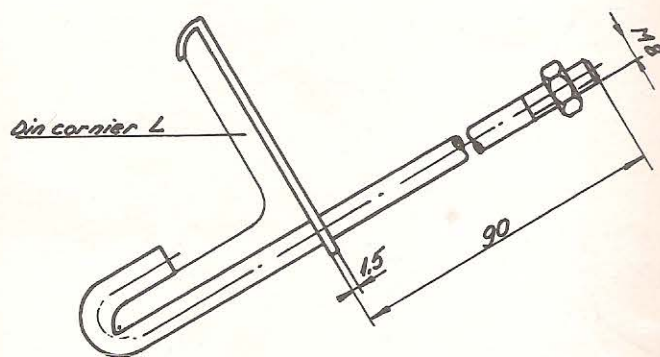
d. Tijă galvanizată filetată, cu opritor, pentru pană metalică din țevă
